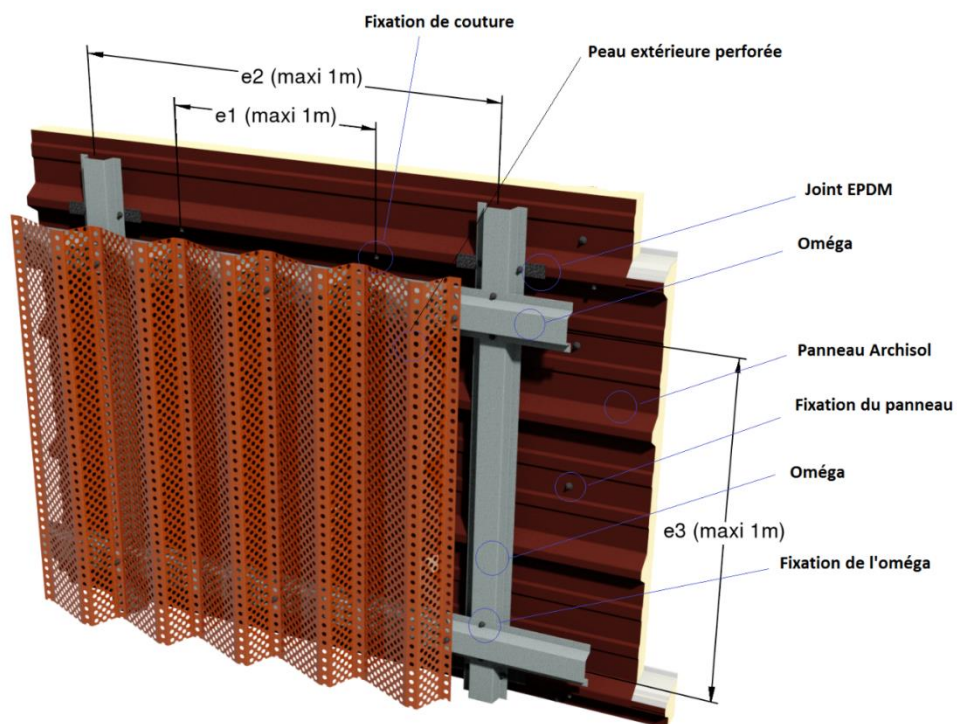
Vue 3D - Dessin de principe - panneau horizontal, double réseau d'ossature parement perforé
